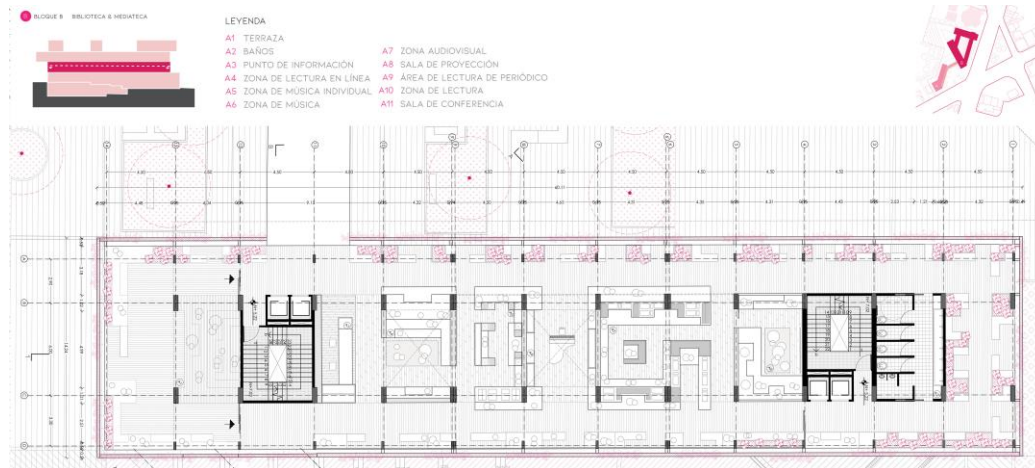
Planta II – Bloque B1. Fuente: (Andrade, 2019).
